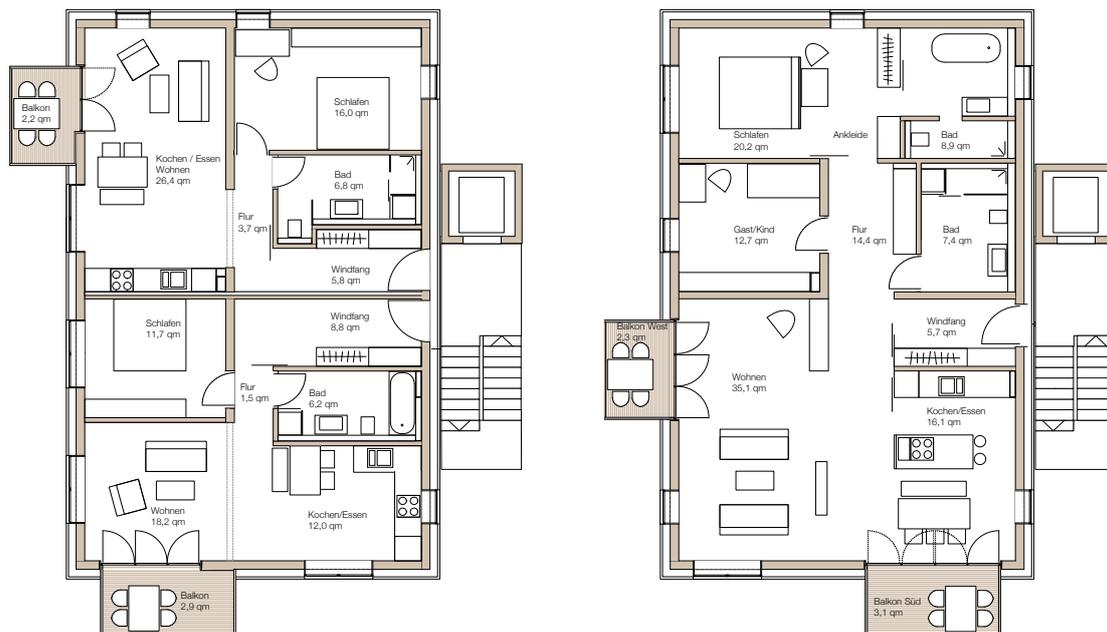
Grundriss 2. Obergeschoss / 3. Obergeschoss
